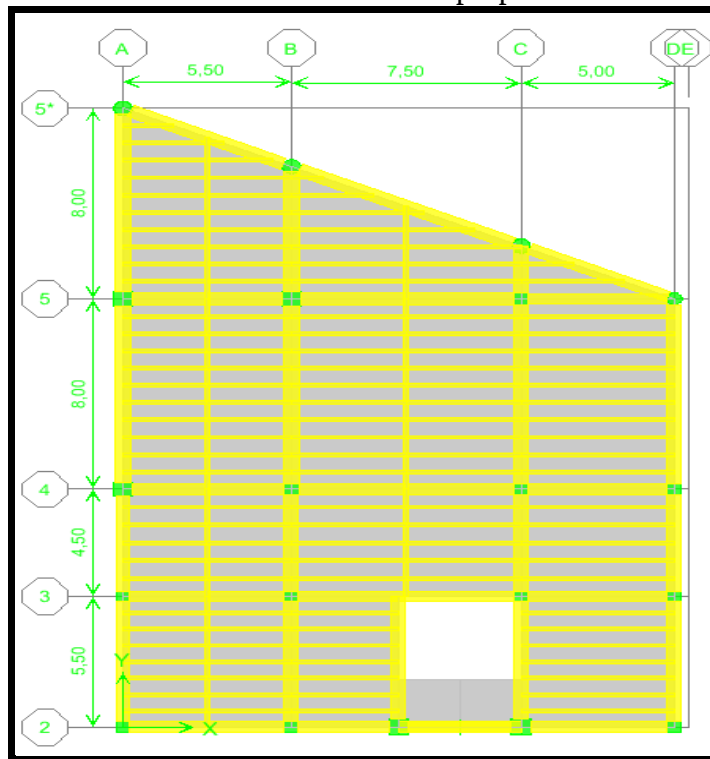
Planta de Nueva Configuración Módulo 3 (Edificio Norte)
